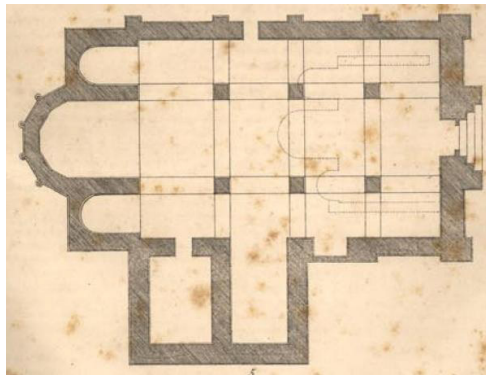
Planta da extinta igreja de São Cristóvão.
